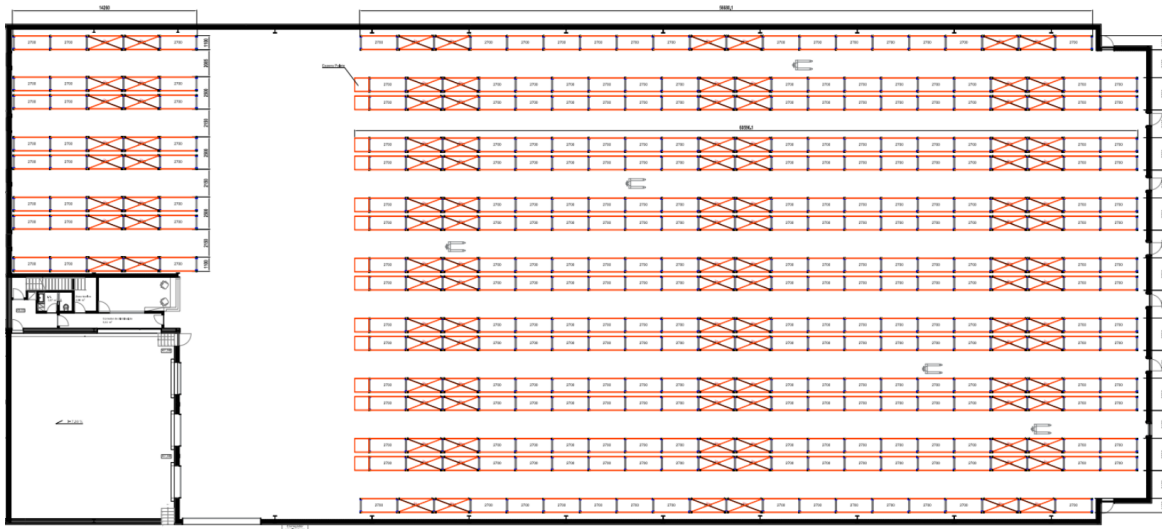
Layout* do novo armazém da Casa Peixoto
